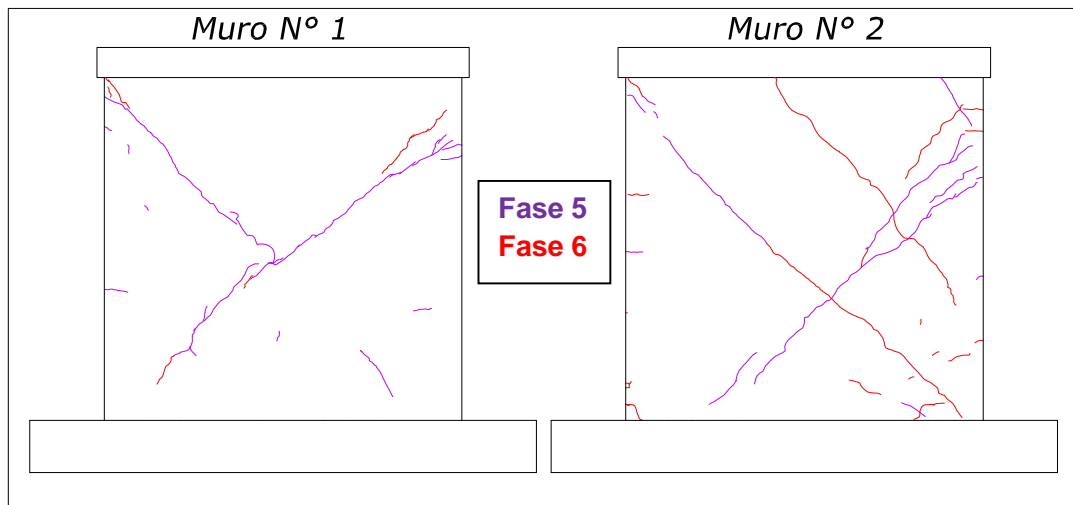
Fisuras en las Fases 5 y 6
